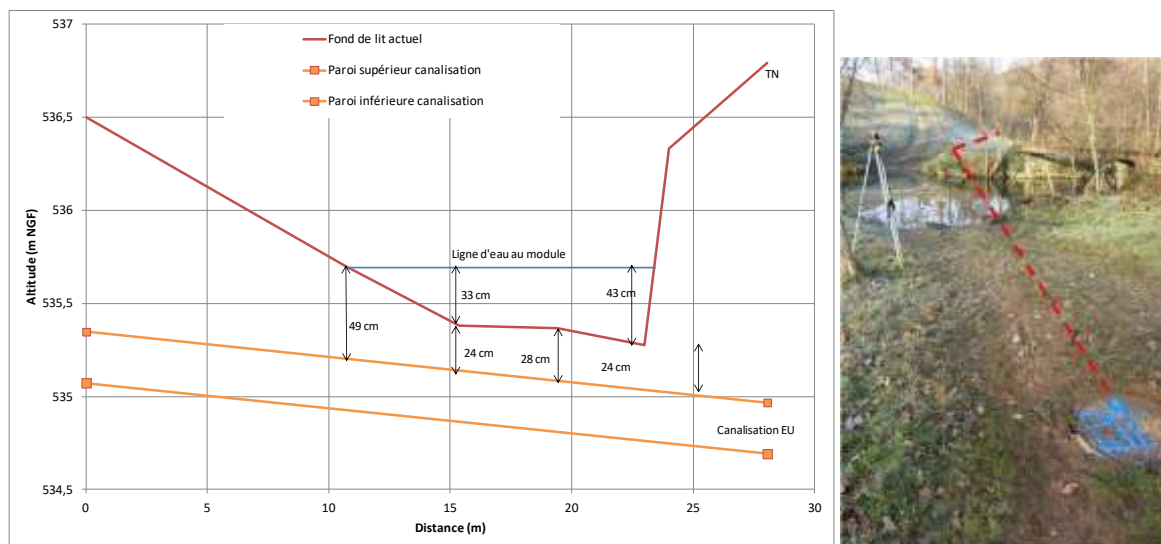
Profil en travers au droit de la canalisation d'eau usée
